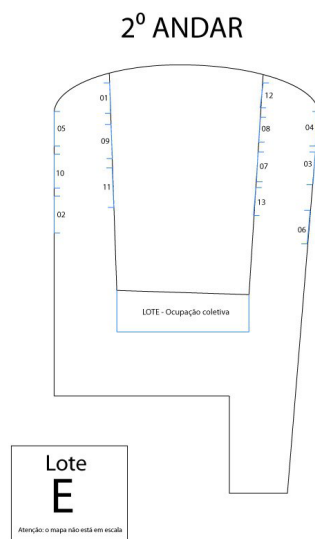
Planta baixa do IA com demarcações dos lotes. 2º andar.
